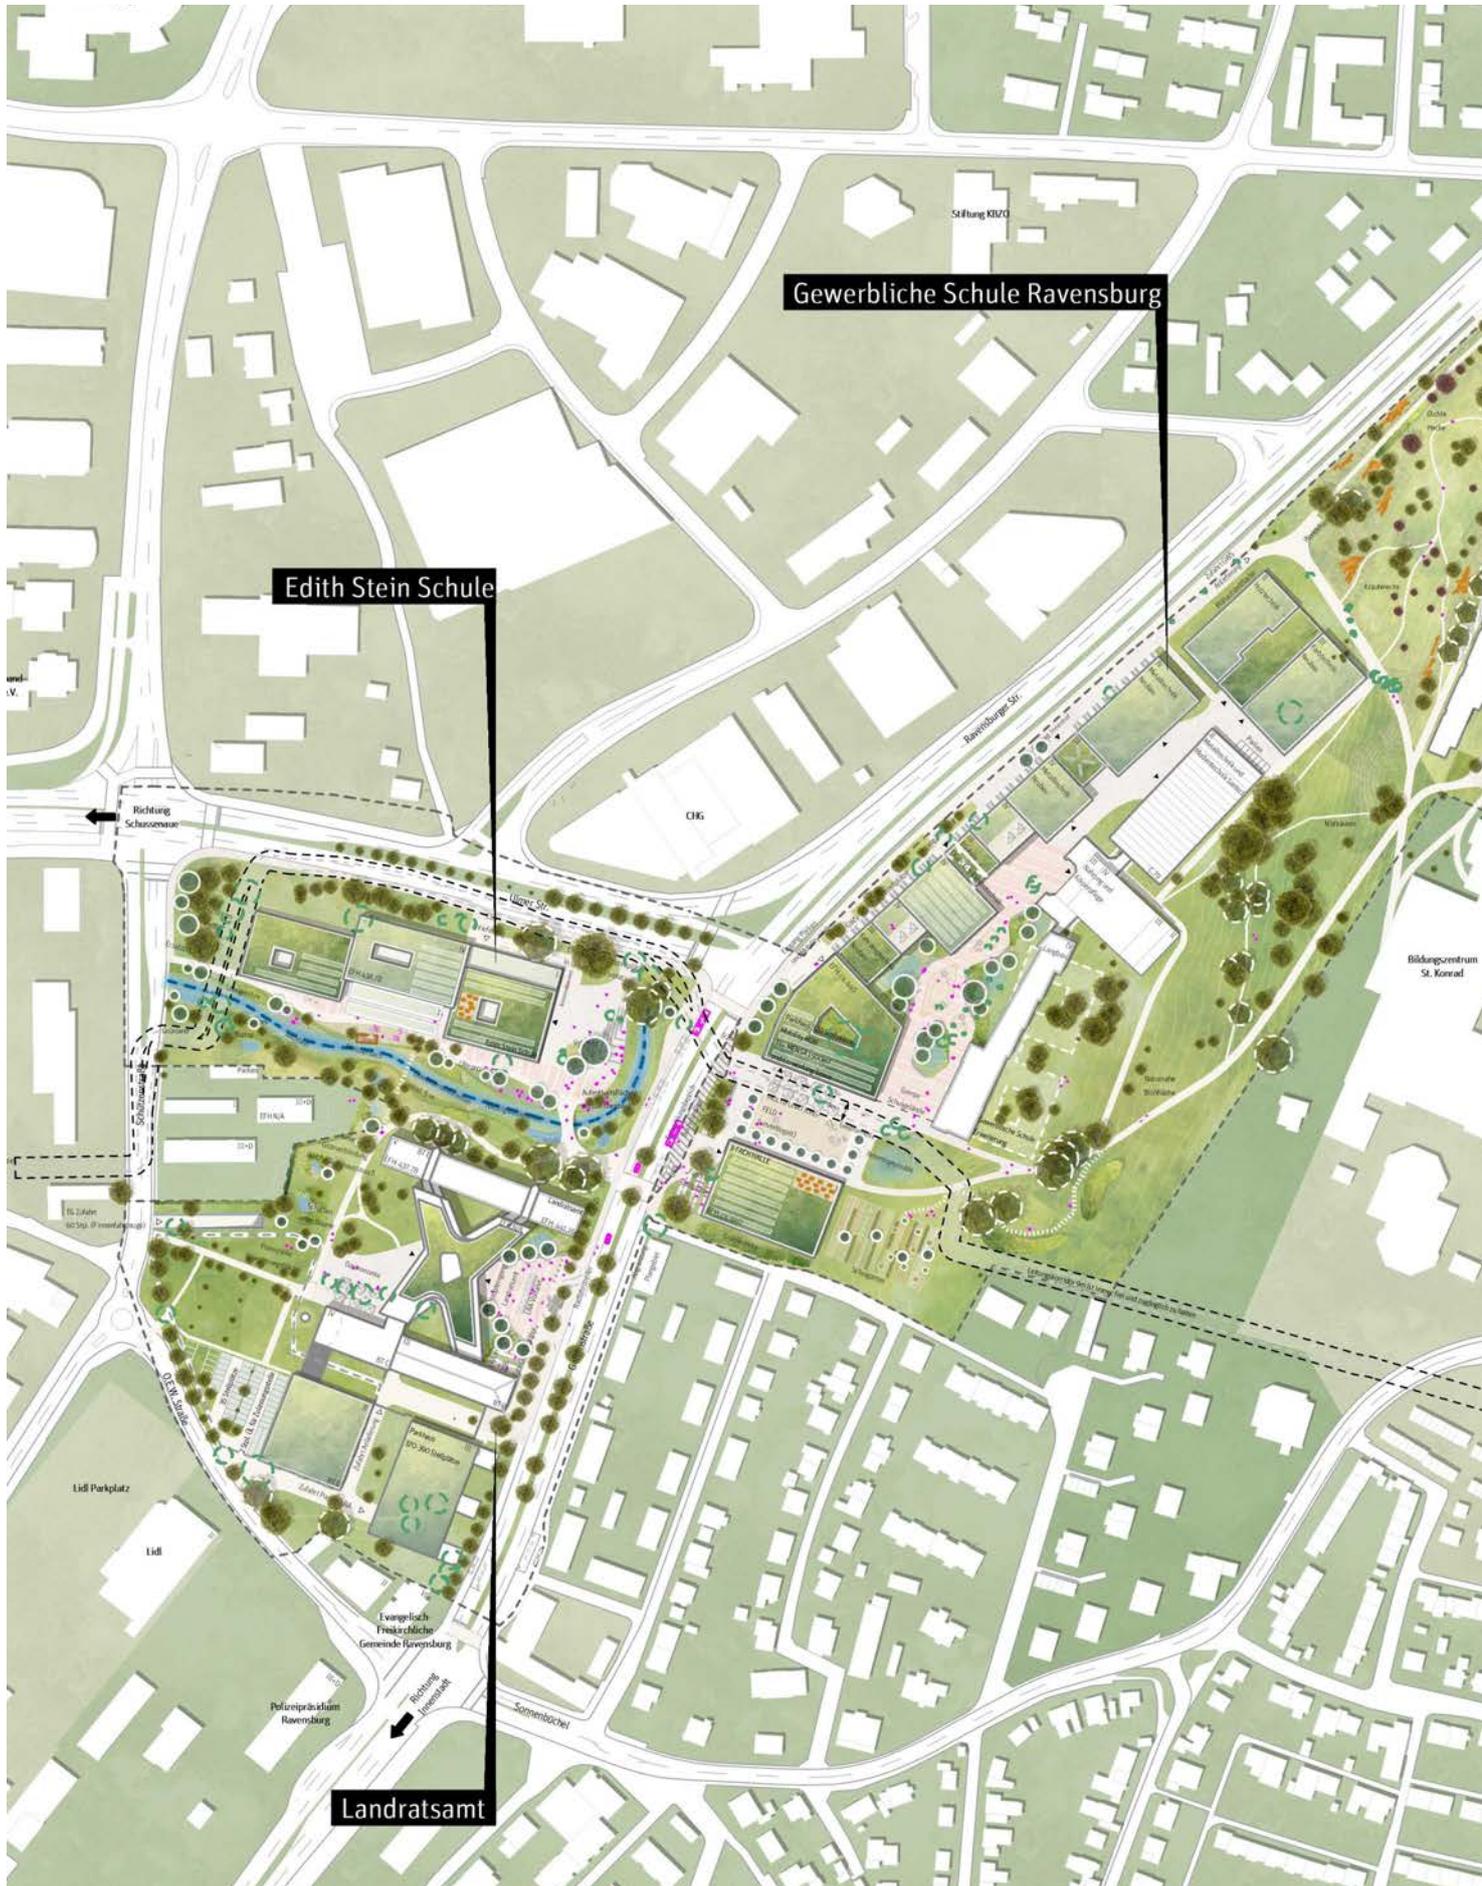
Rahmenplan Landkreis Campus Ravensburg
